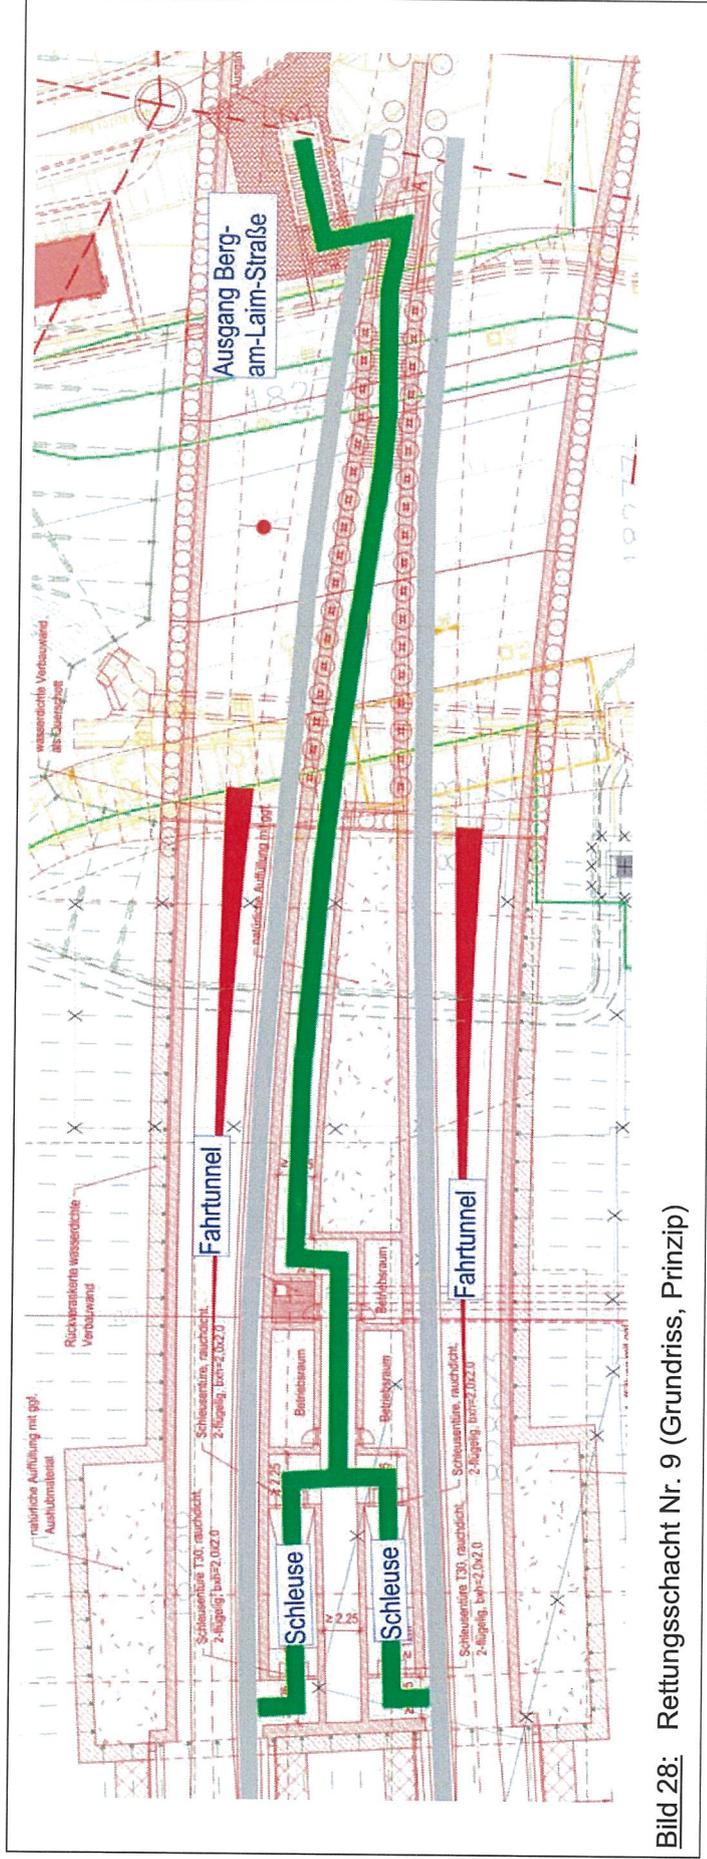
Rettungsschacht Nr. 9 (Grundriss, Prinzip)
